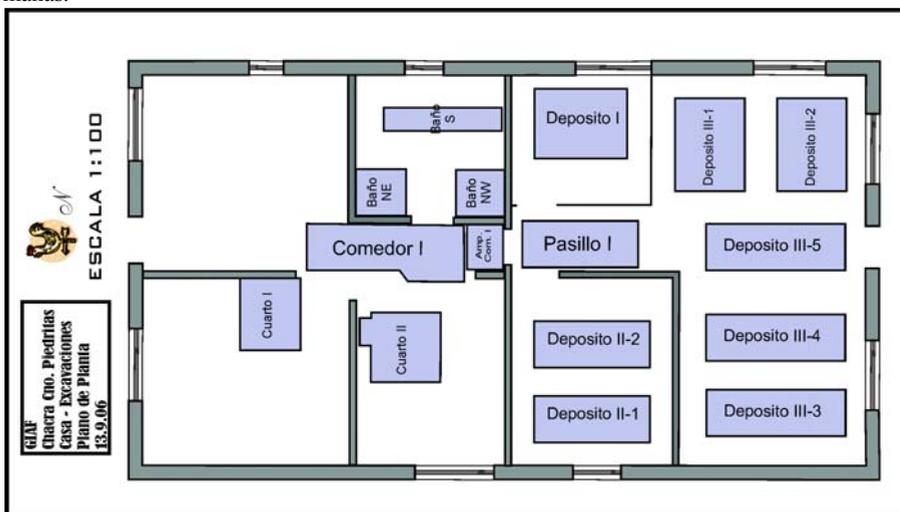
Plano de Planta de la Casa con las intervenciones arqueológicas efectuadas.
